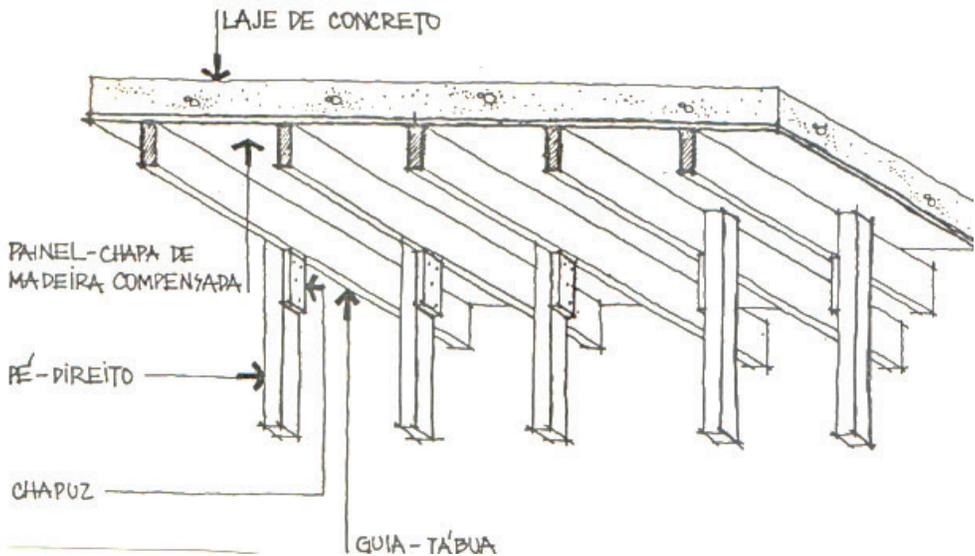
Esquema de fôrma convencional para laje, utilizando-se apenas guias
